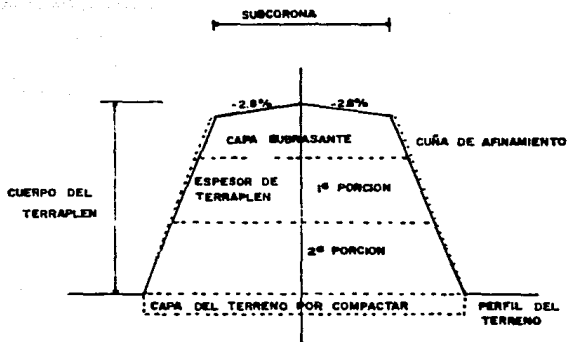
SECCION TRANSVERSAL EN TERRAPLEN.
